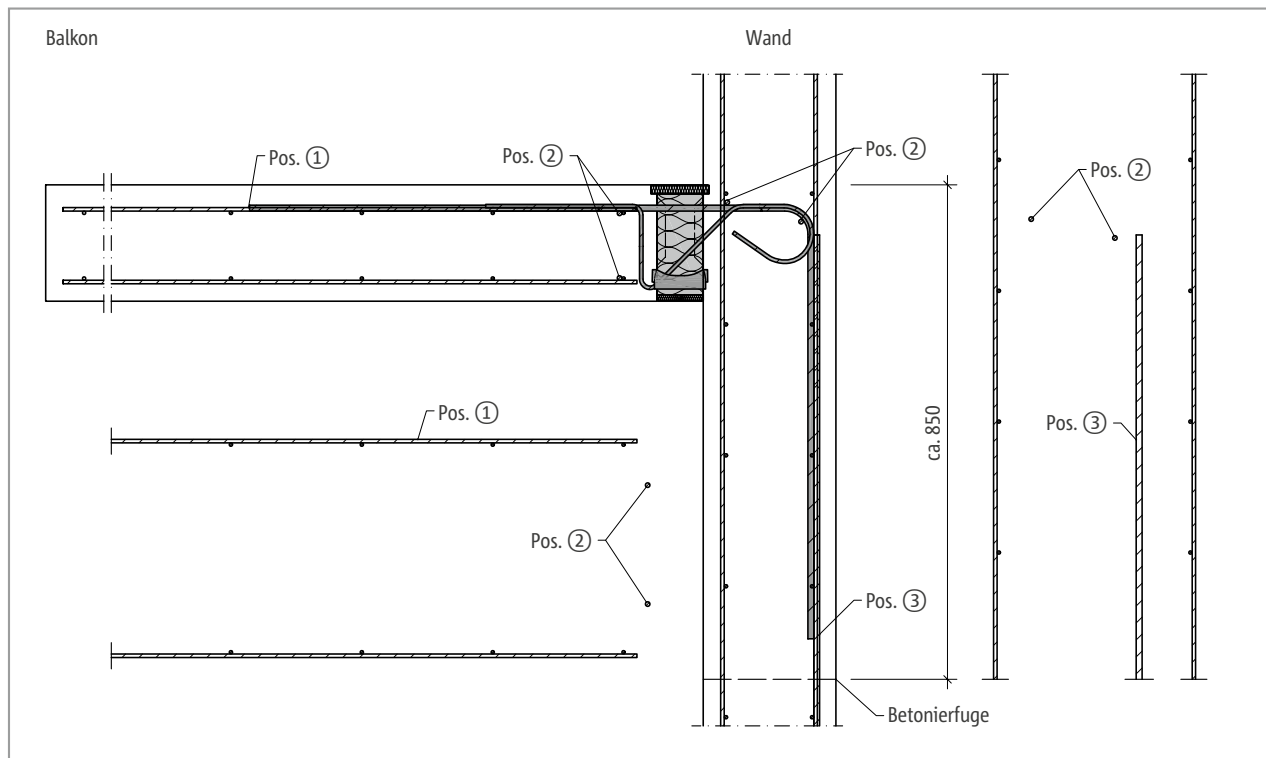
Schöck Isokorb® T Typ K-WU: Bauseitige Bewehrung
